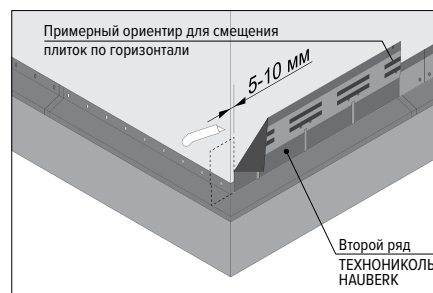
Монтаж первого и последующих рядов фасадной плитки
